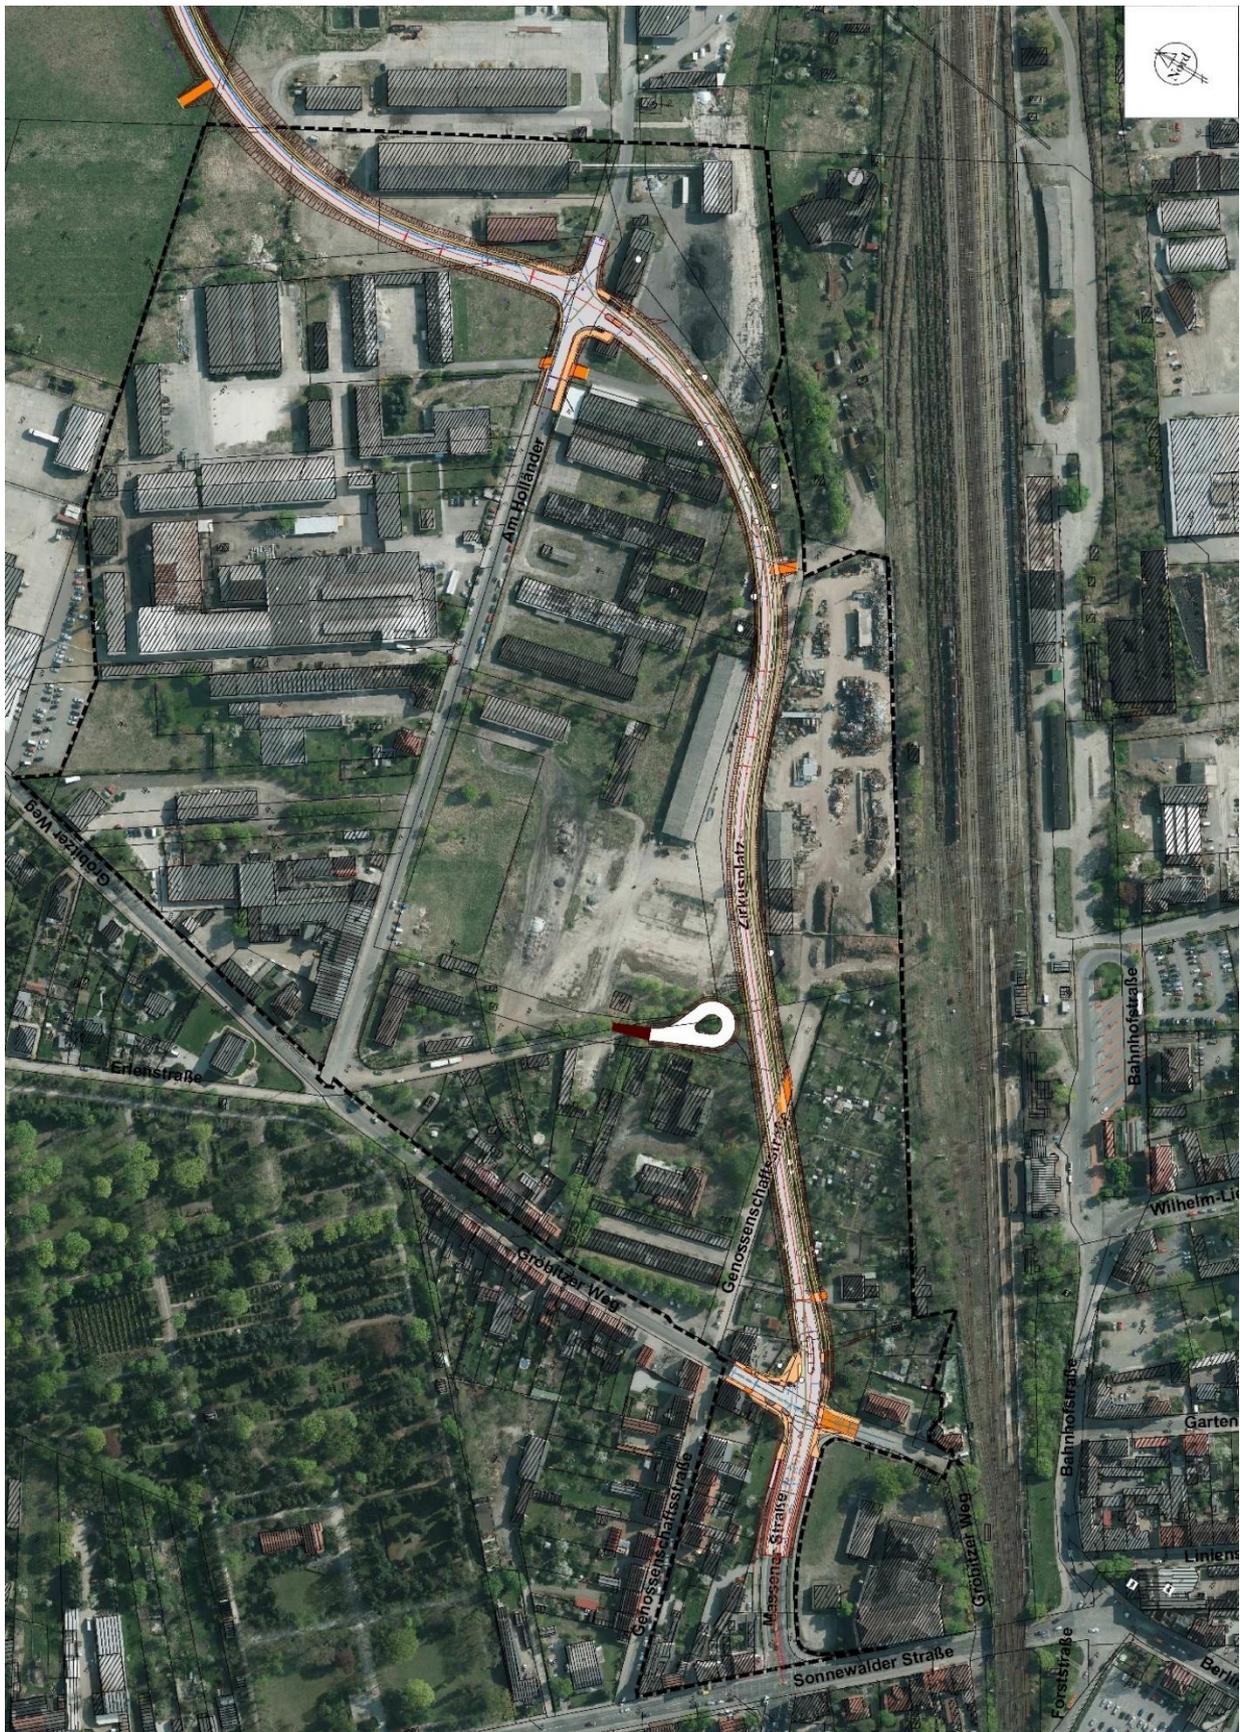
Übersichtsplan Luftbild mit planfestgestellter B 96
